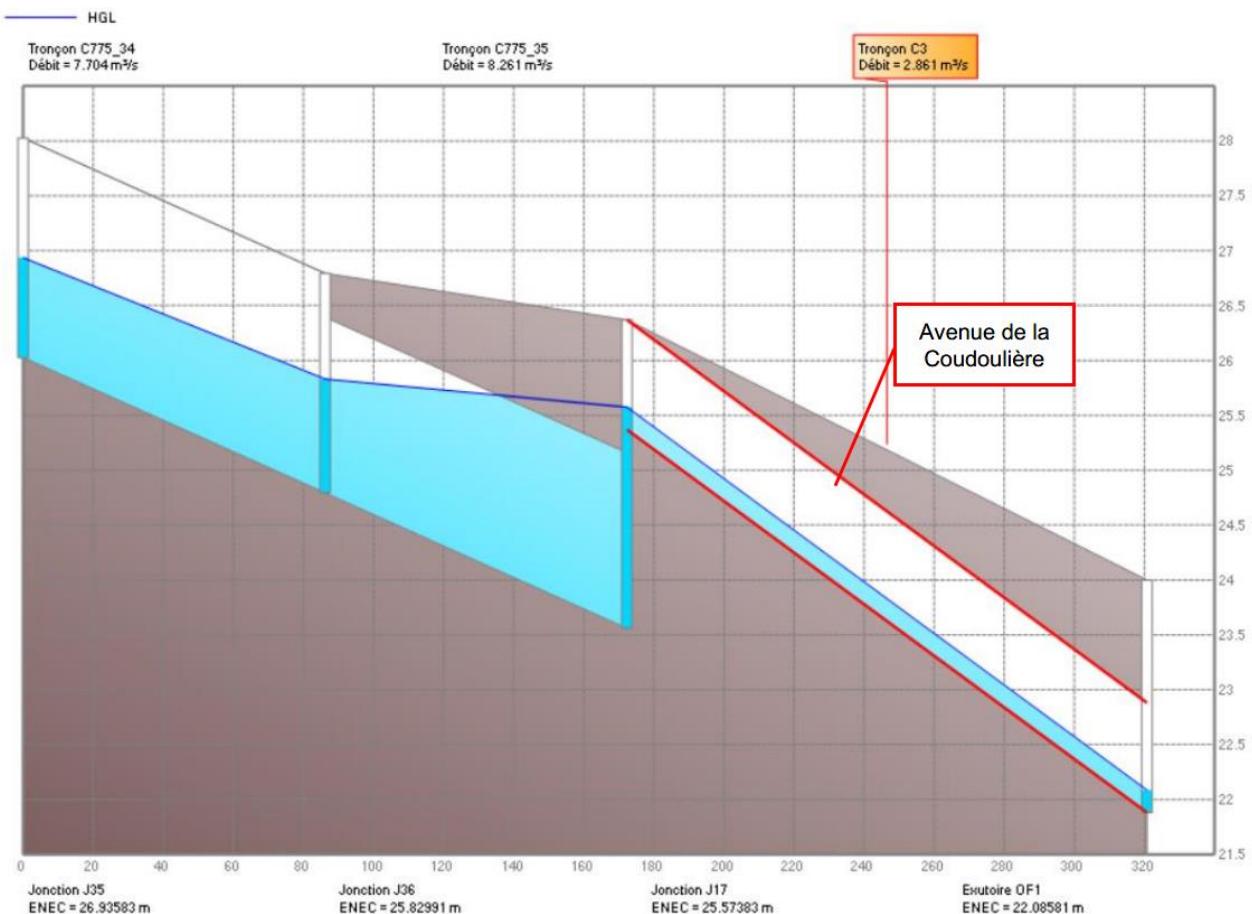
PROFIL EN LONG SUR L'AVENUE DE LA COUDOULIERE POUR Q10
